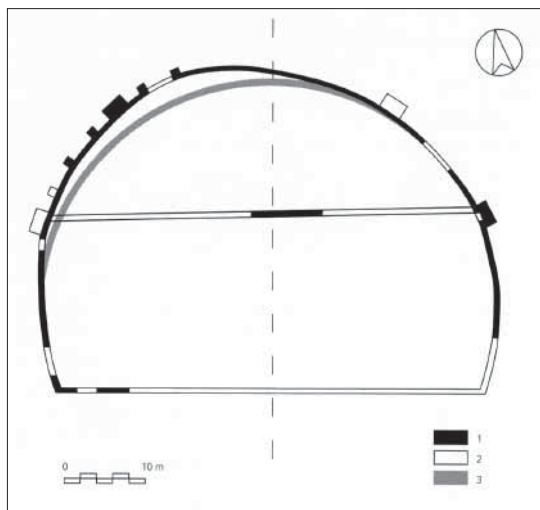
Premier théâtre (état 1a). Plan restitué.
